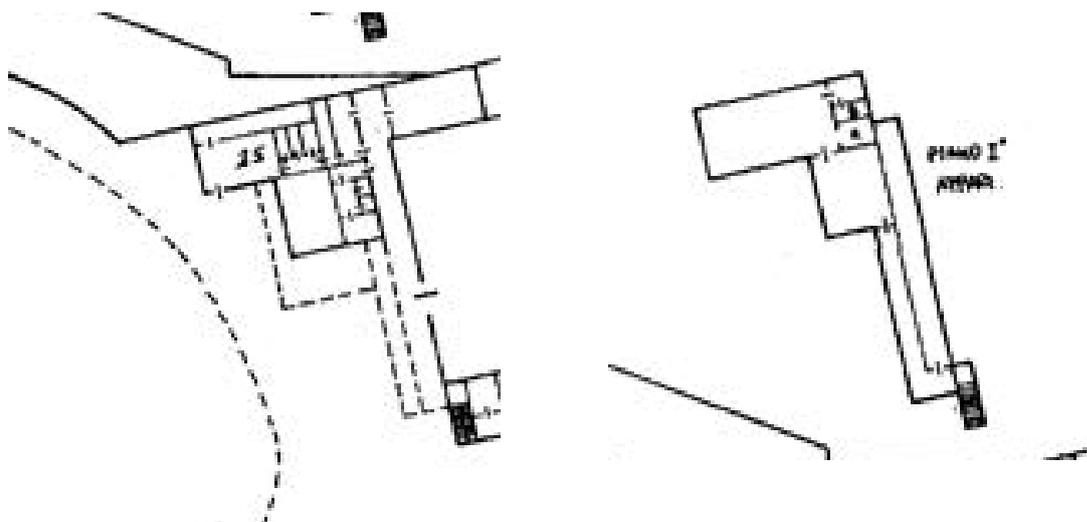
Planimetria Catastale edificio A - Piano terra - Piano primo
